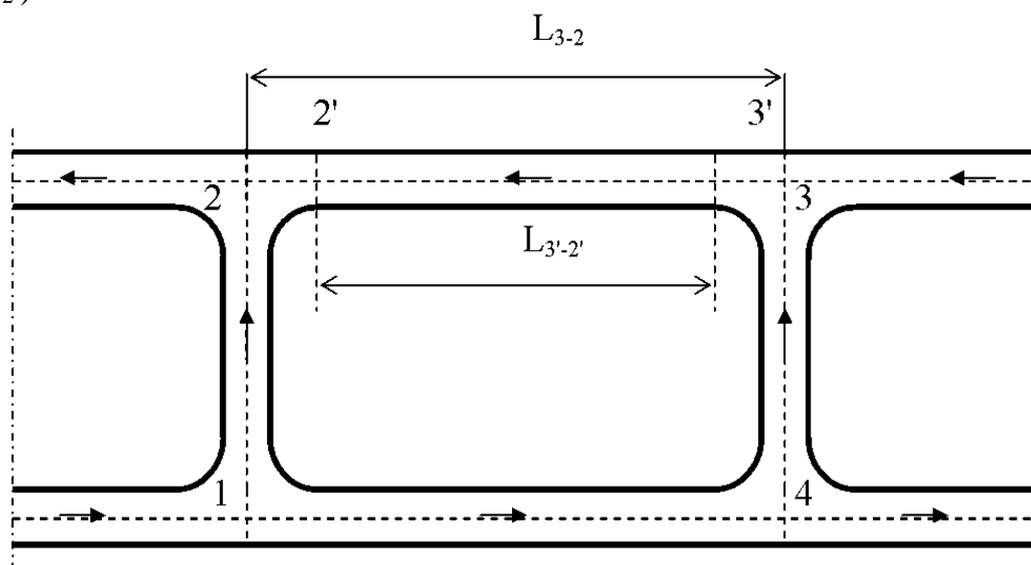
Схема соединения горных выработок в вентиляционном контуре
